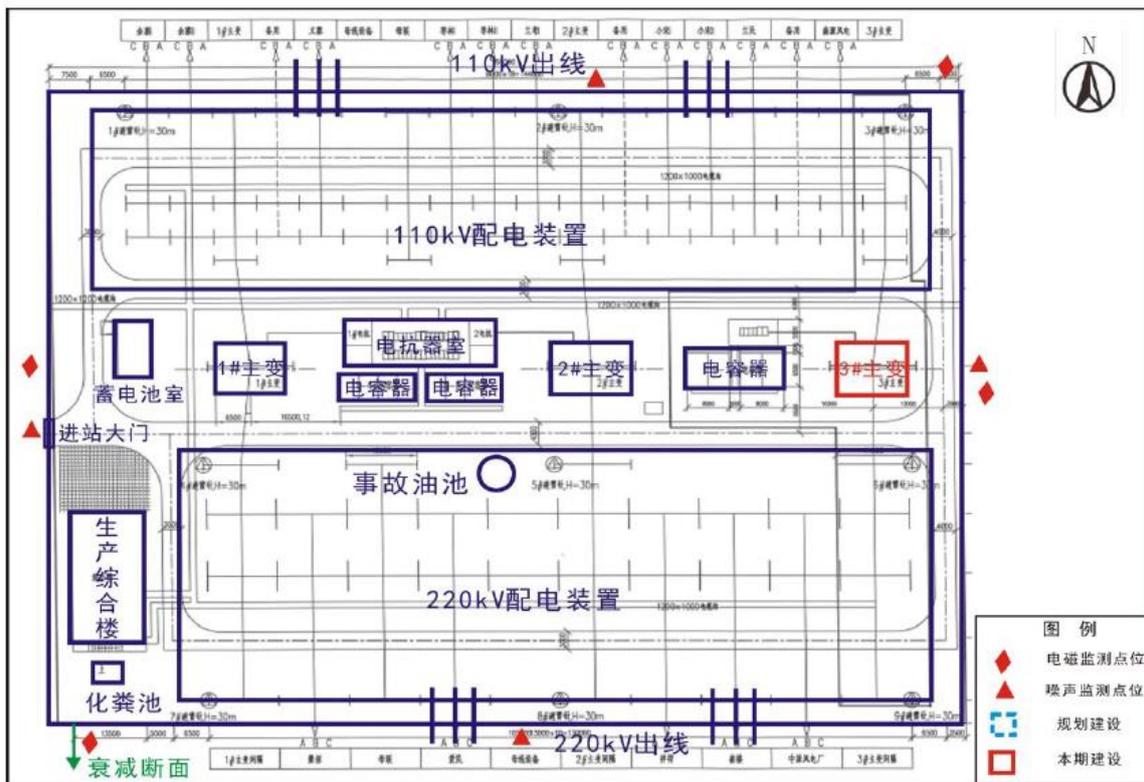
开封兰考 220kV 景文变平面布置及监测布点示意图
